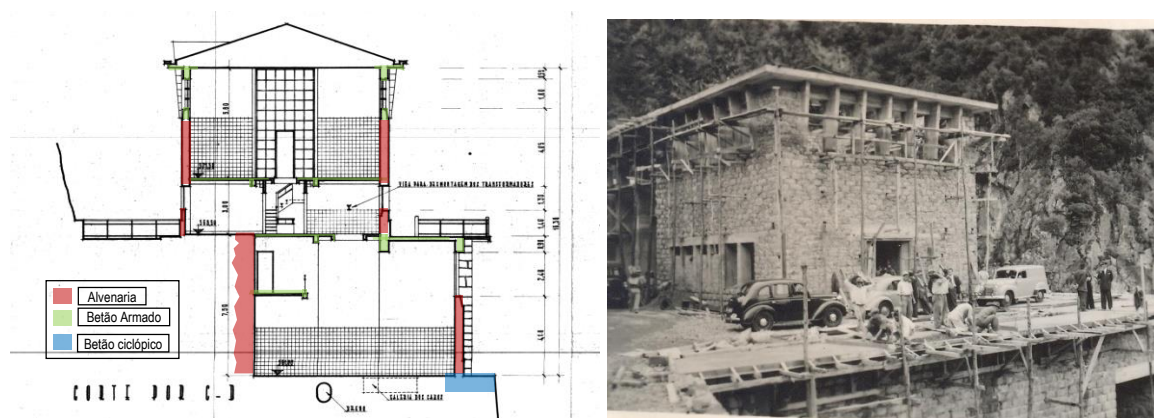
Análise dos materiais e solução construtiva do edifício existente [2]; e fotografias da construção (arquivo EEM).
